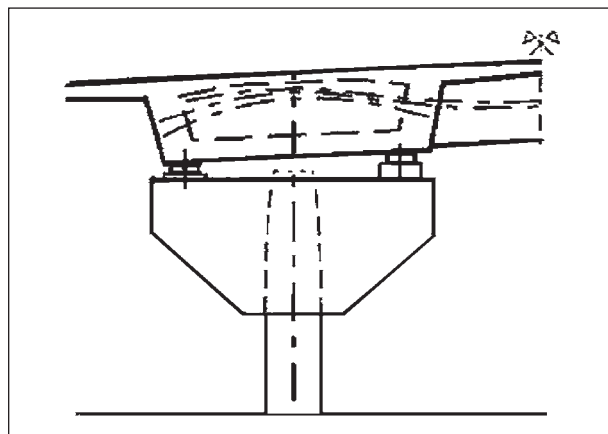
Stützensausbildung als Hammerkopf (HeBeKa07)
